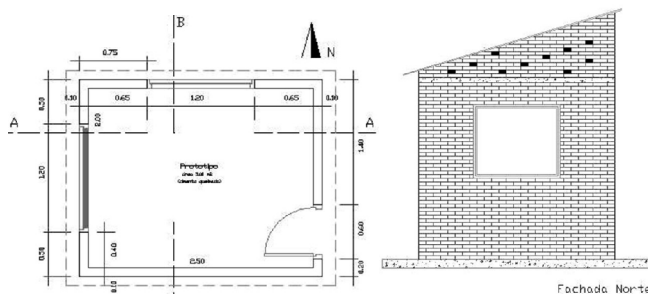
Planta, vista e corte esquemático da célula-teste.
